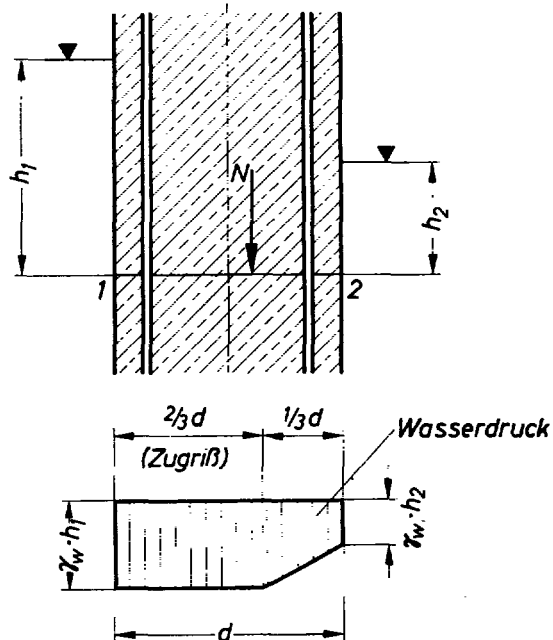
Wasserdruck in einem Stahlbetonquerschnitt.
